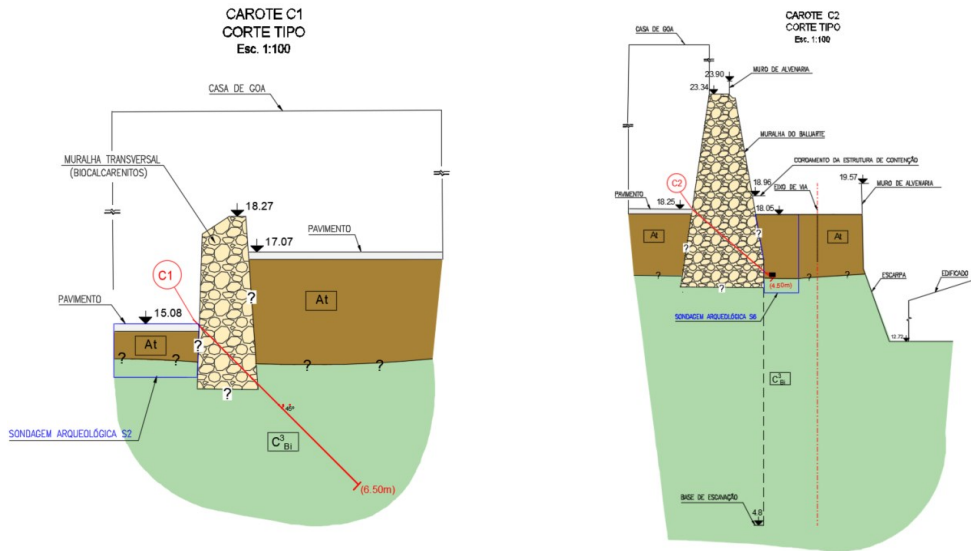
Corte transversal na zona da carote C1 (esquerda) e corte transversal na zona da carote C2 (direita)
